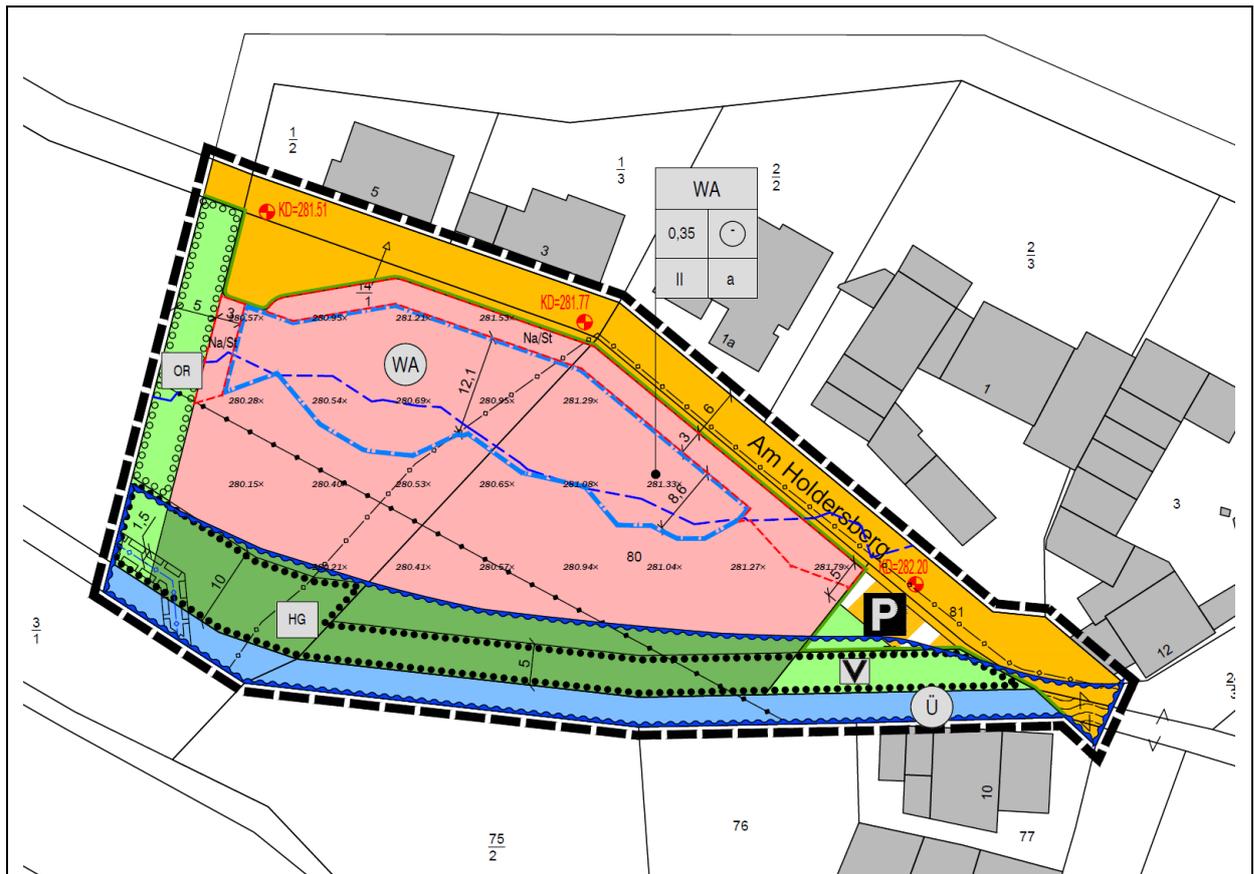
Darstellungen des Bebauungsplans (Stand Entwurf 02-2023)
